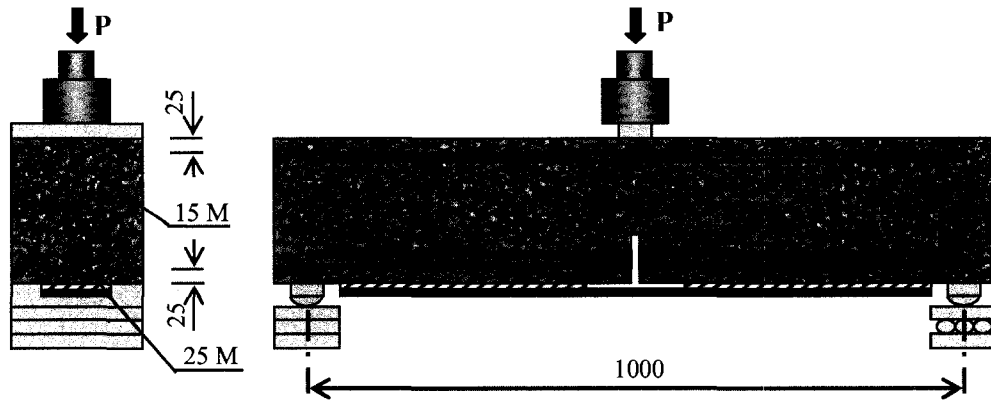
Poutrelles du Groupe E : poutrelles en béton fibré (BF)
